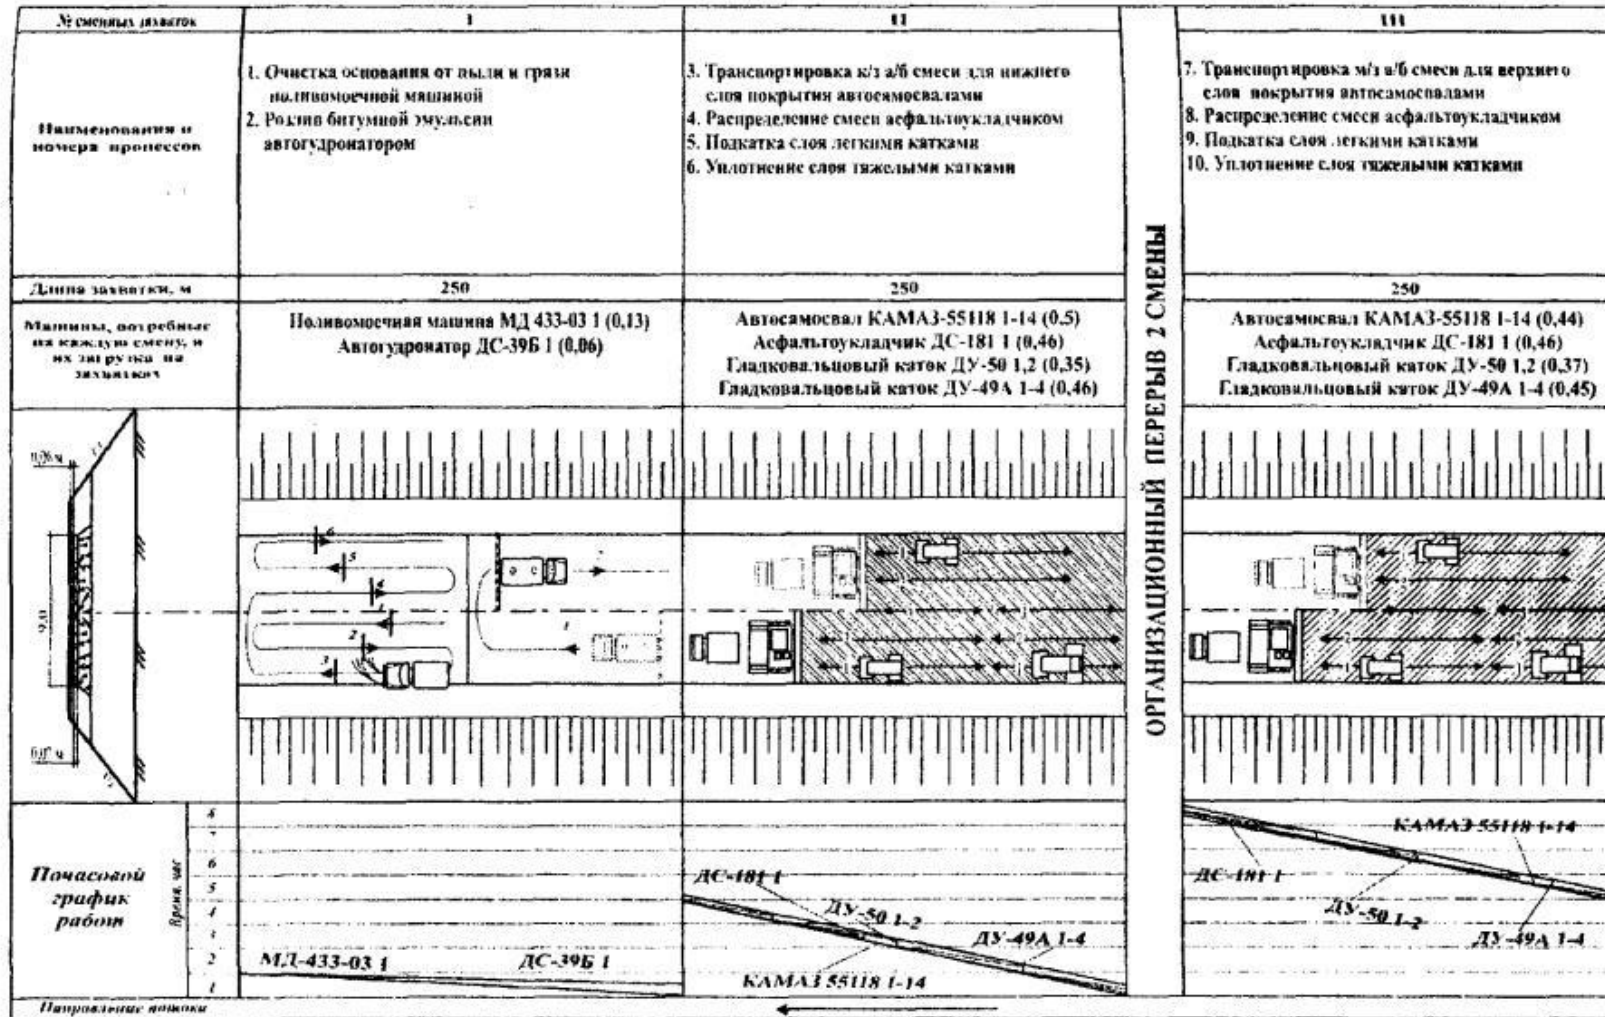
Технологічний план потоку по влаштуванню двошарового асфальтобетонного покриття
